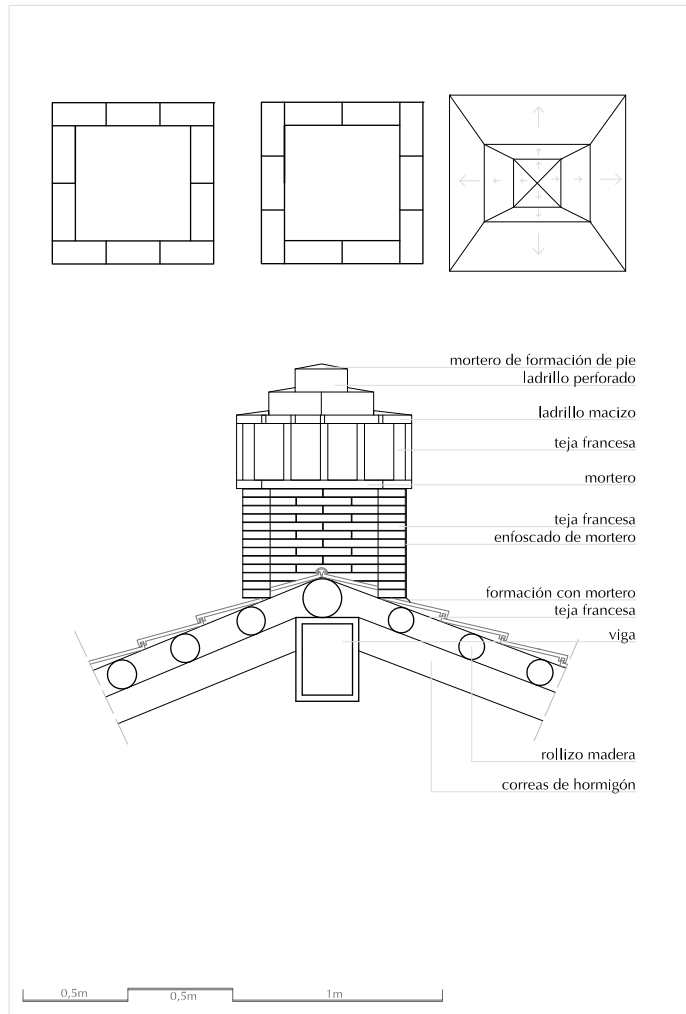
Detalles constructivos de chimeneas de ventilación.
